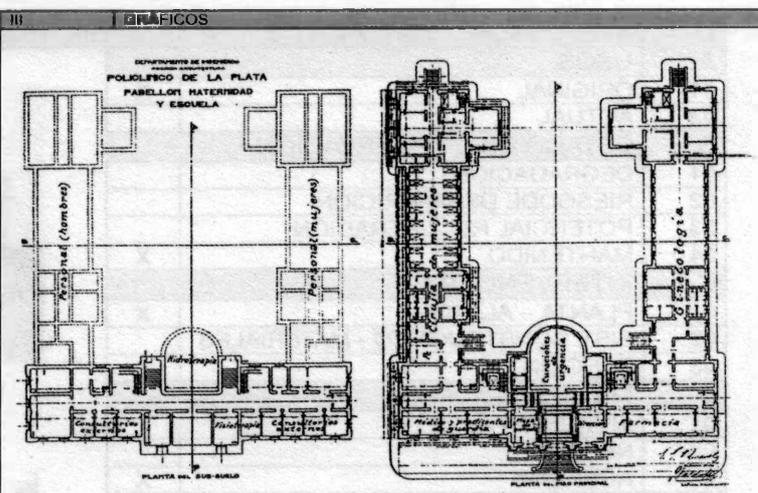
PLANTA BAJA Y SUBSUELO. 1918
